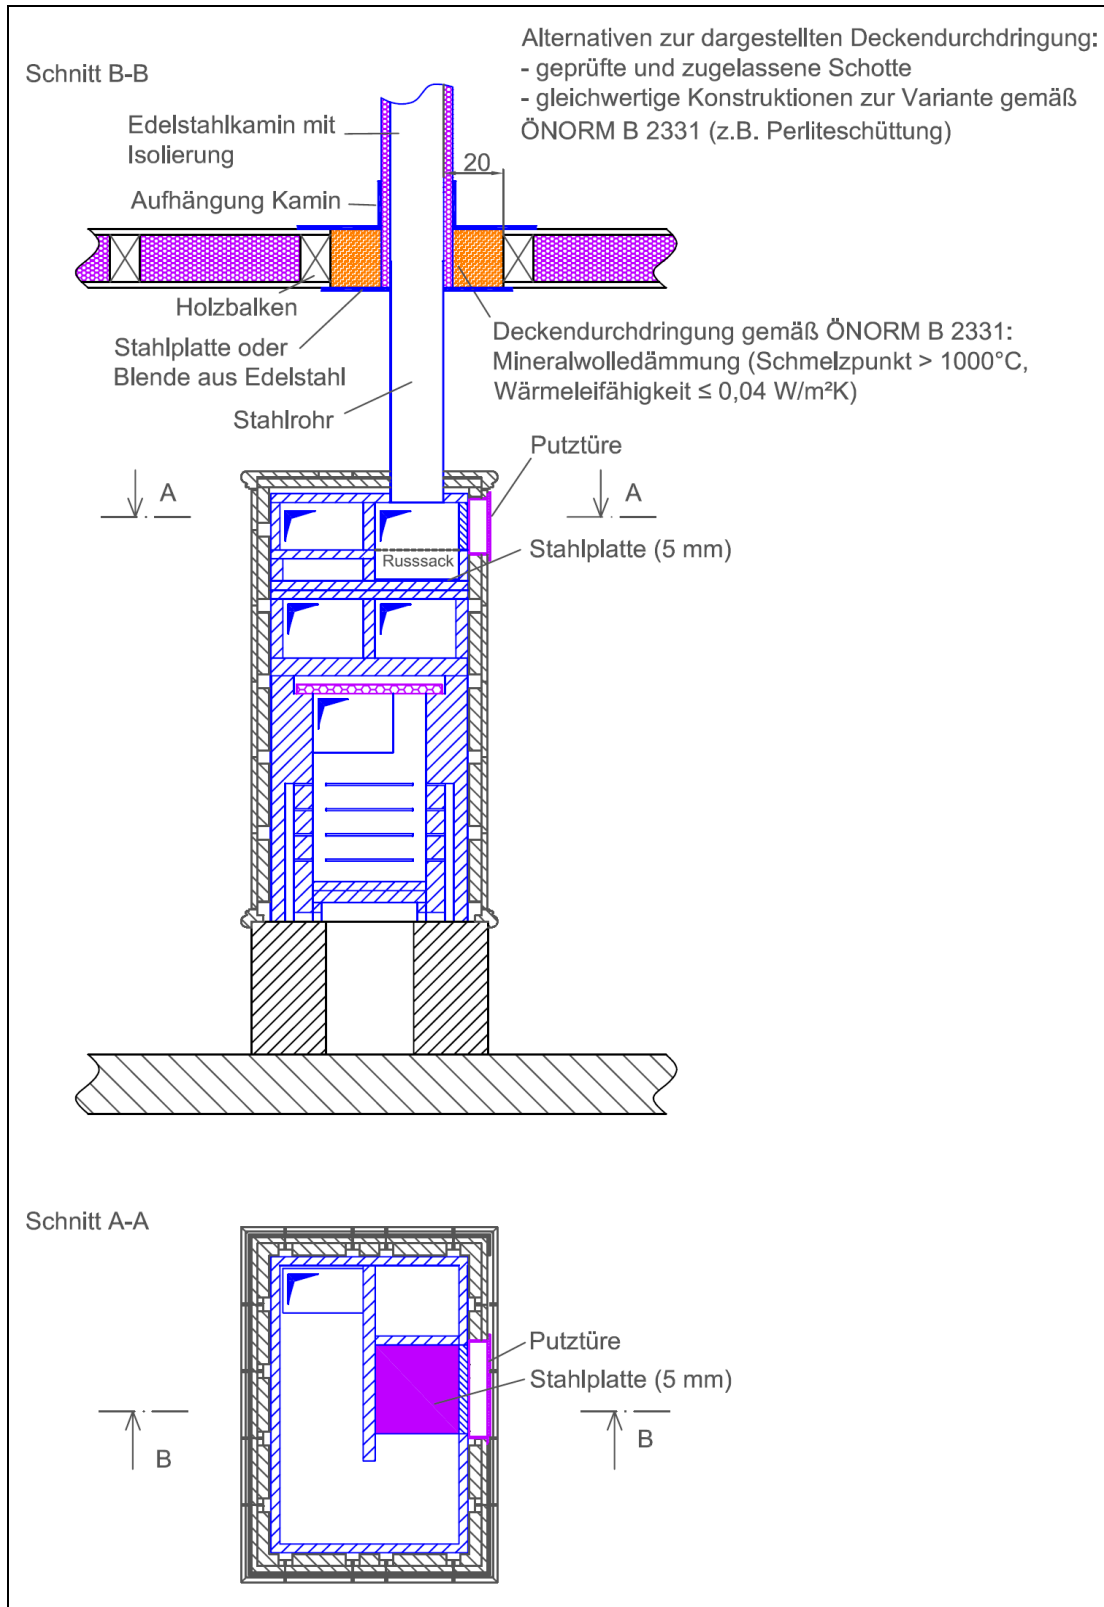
Schwebende Abgasanlage bei einem Kachelofen mit Stahlrohr und Edelstahlkamin aufgesetzt auf brennbare Deckenkonstruktion
